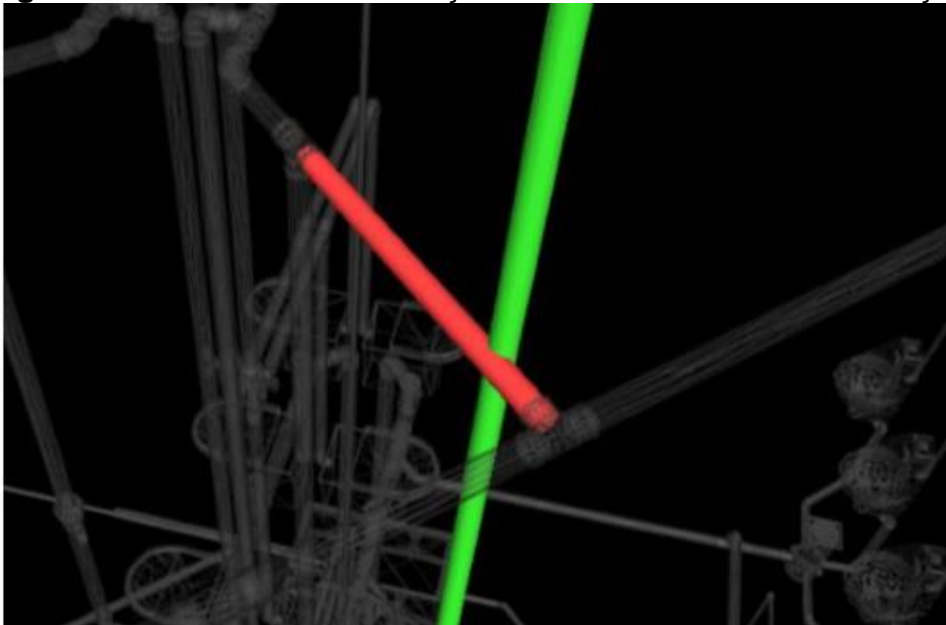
Conflito entre tubulação sanitária e viga do pavimento superior
